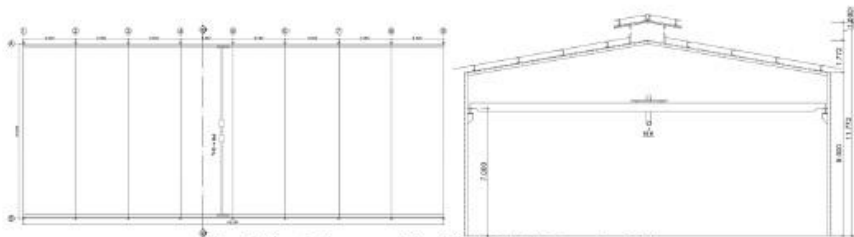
Planta baixa e estrutural do galpão. FONTE: (software AutoCAD)
